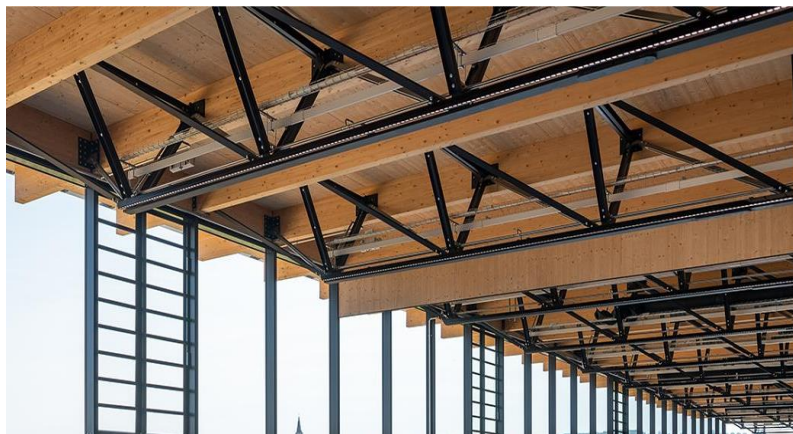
toiture d'un atelier avec des poutres tridimensionnelles
